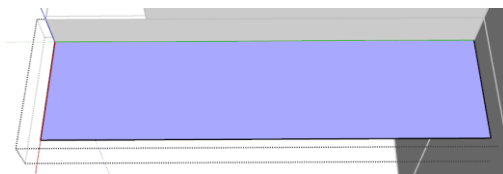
Modeling Lantai yang Telah Digabungkan ke Dalam Ruang
